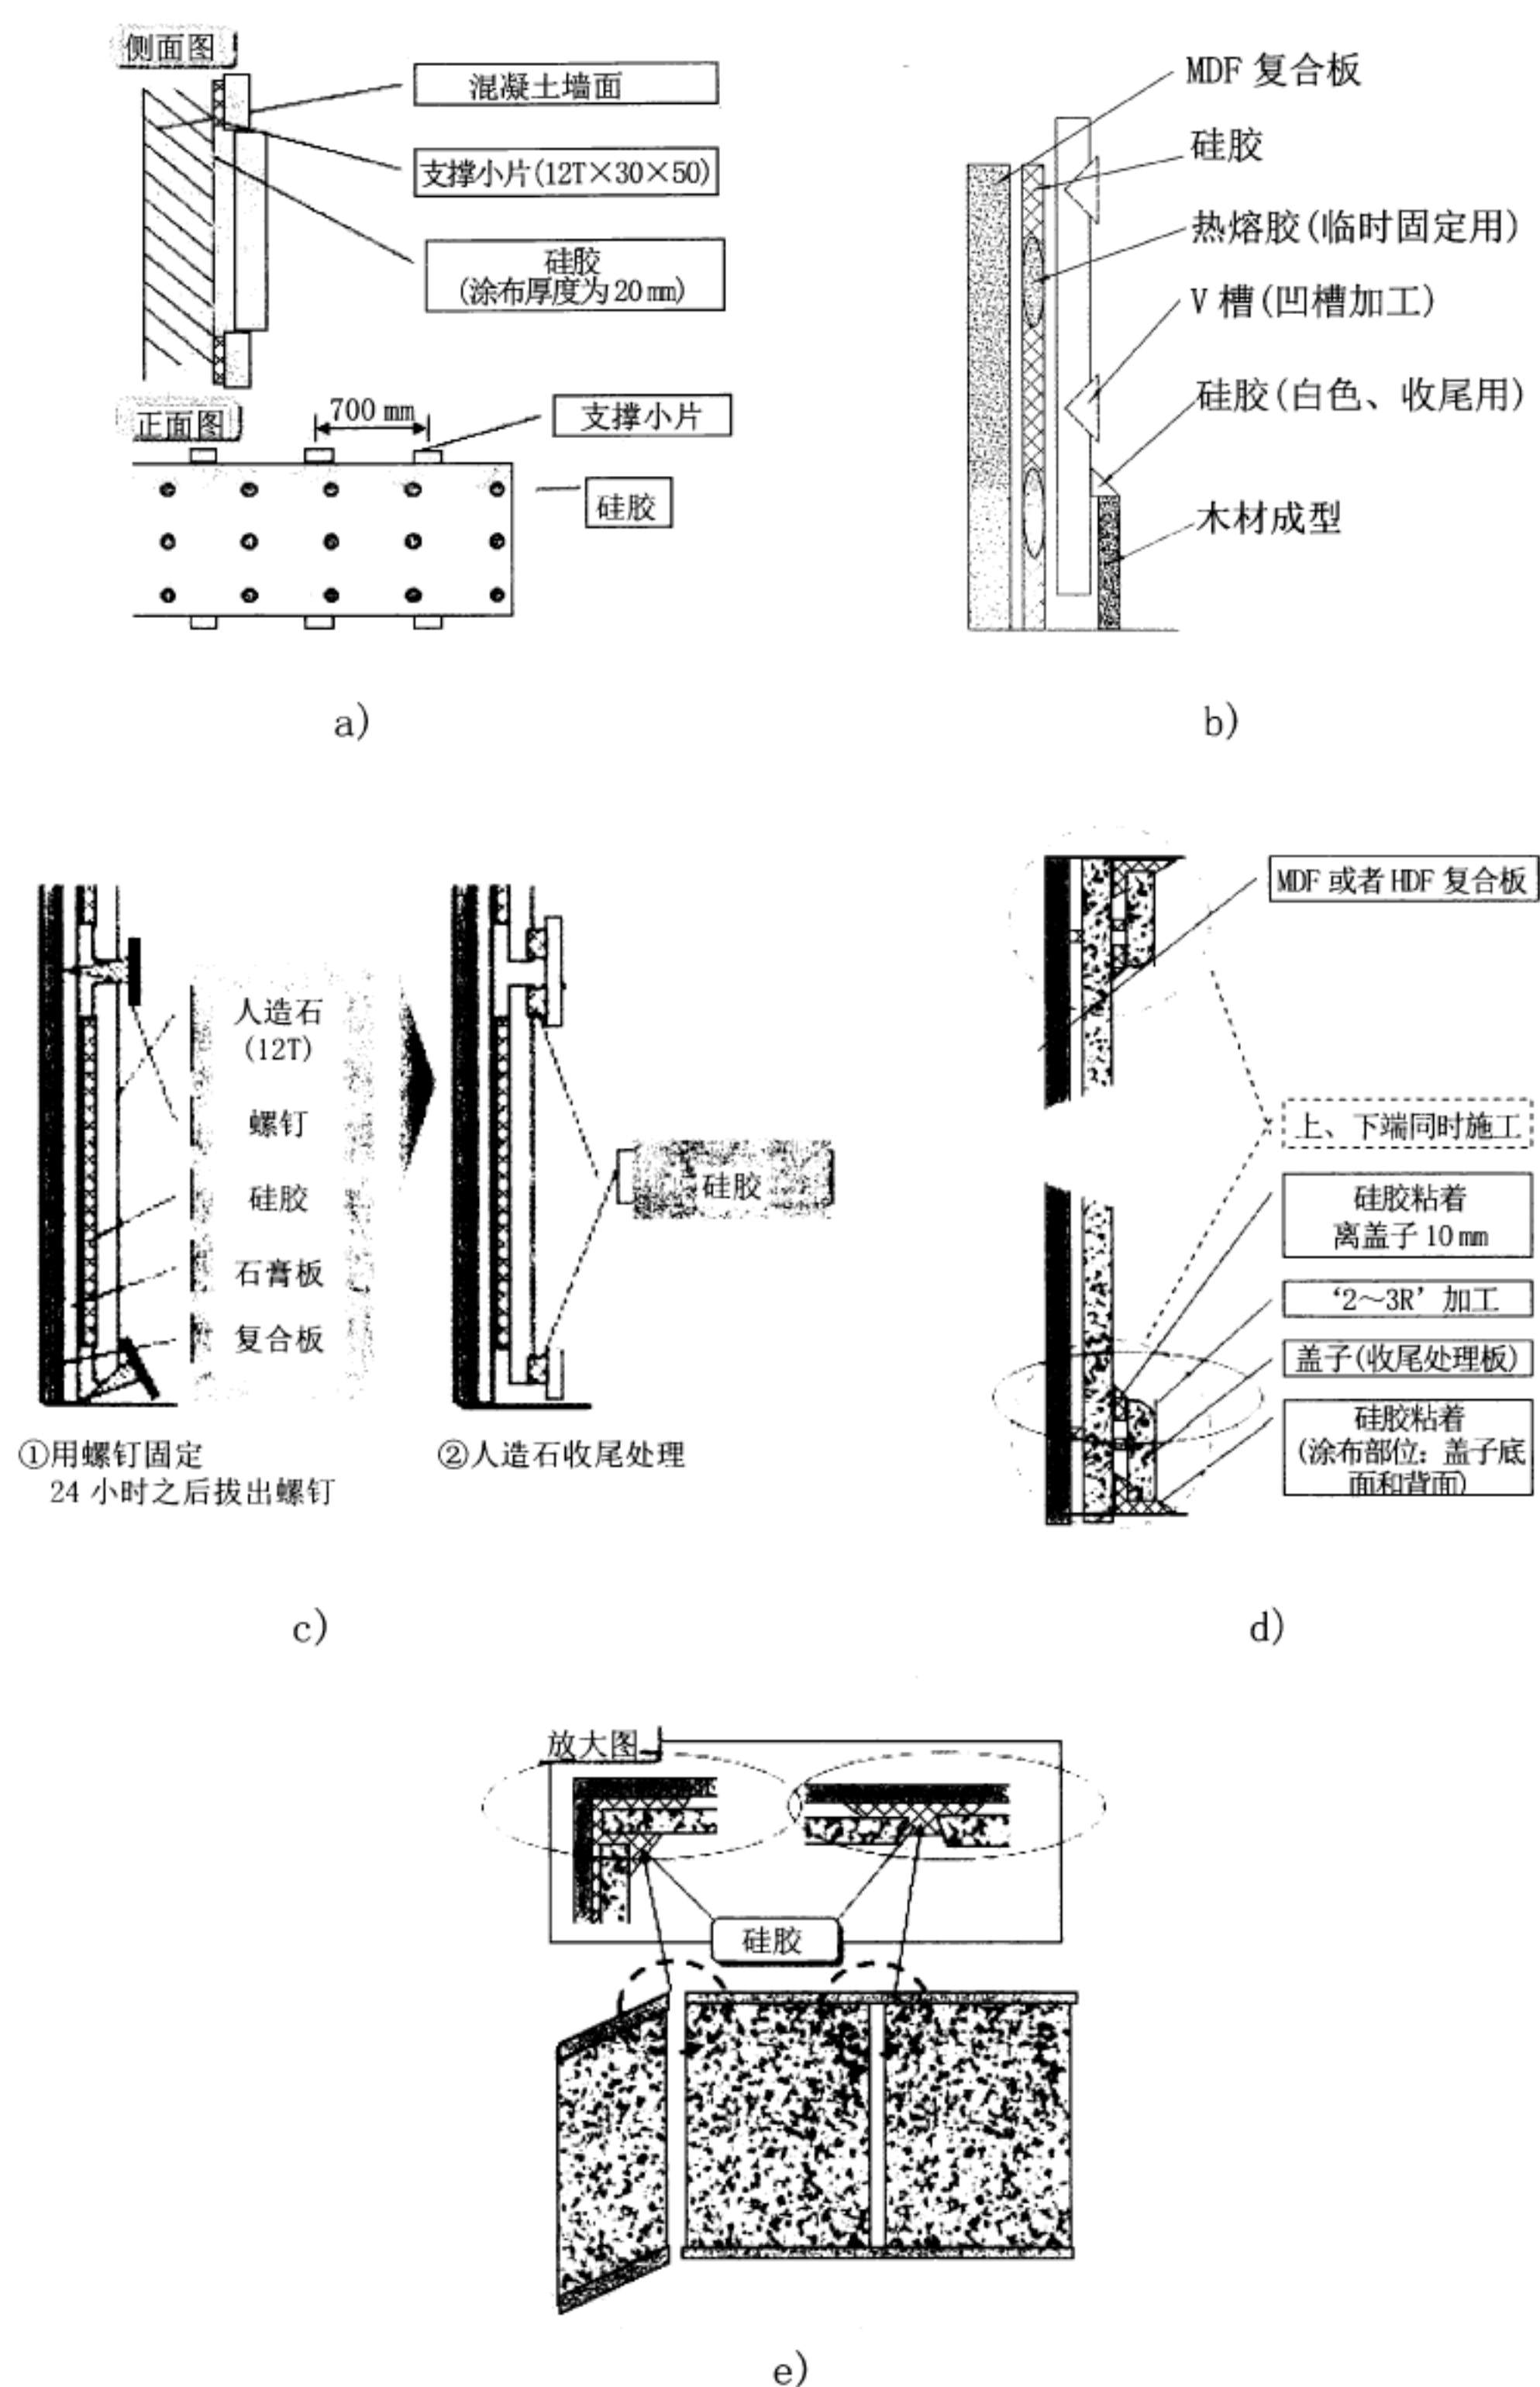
粘贴式墙面加工与施工实例
